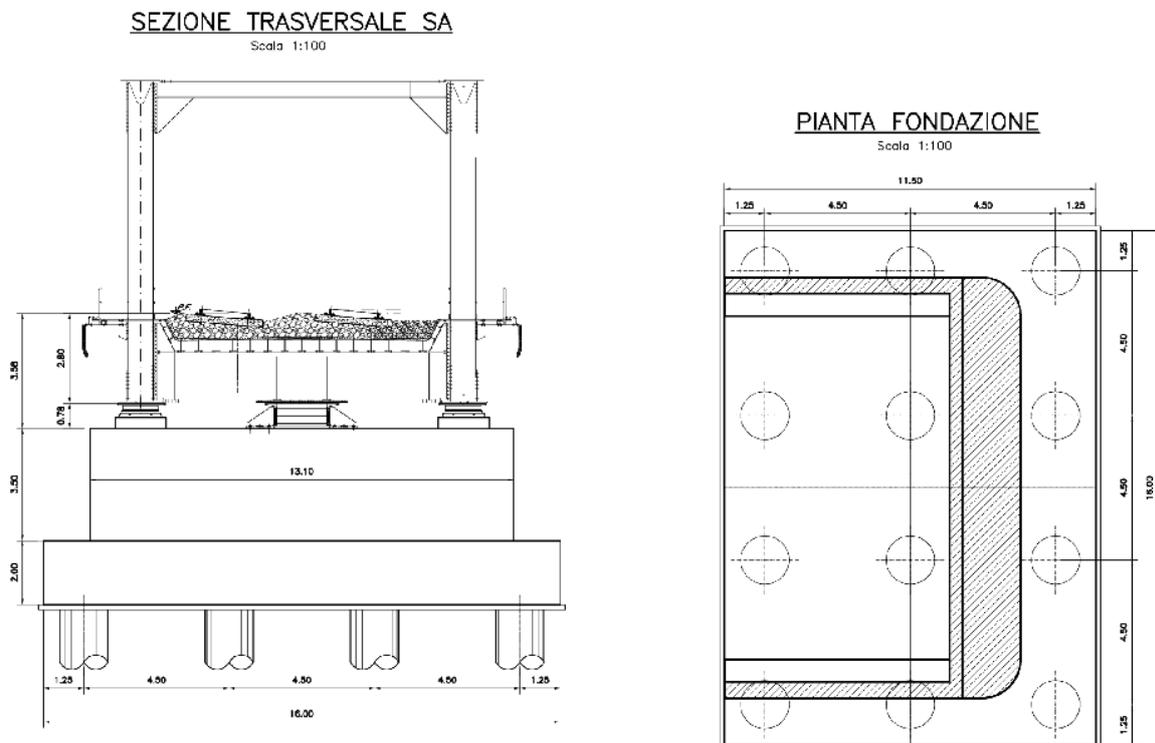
VI03 – Sezione su spalla A e pianta plinto di fondazione
